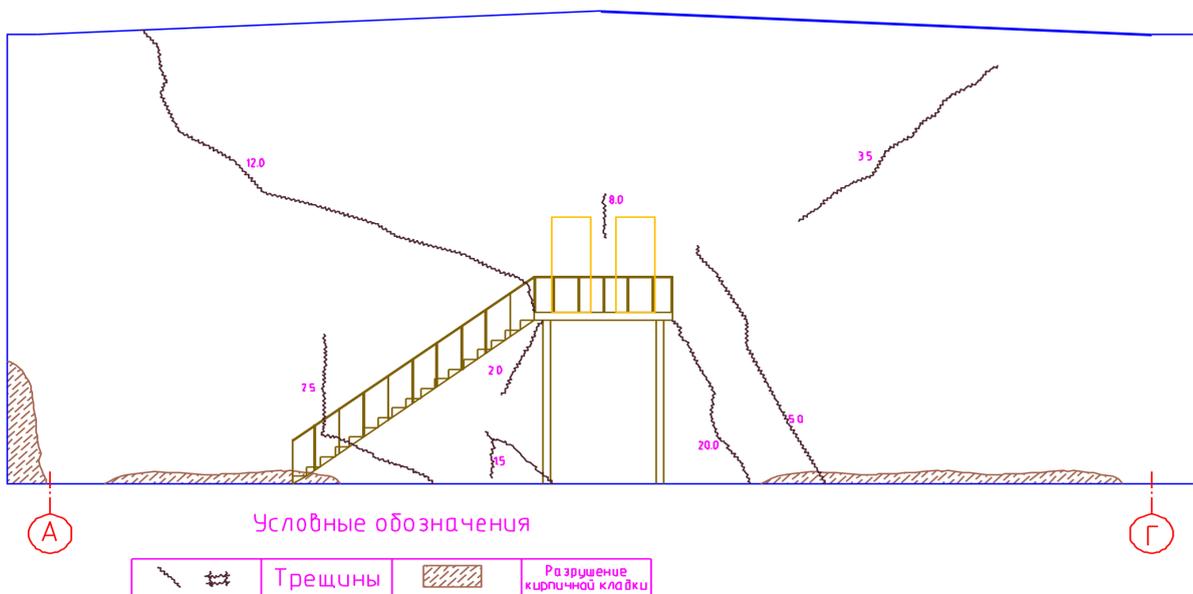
Дефектная карта фасада каменного здания (пример)
